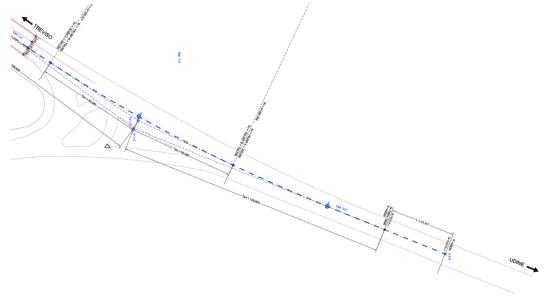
Andamento planimetrico riqualificazione tracciato S.S. n. 13
